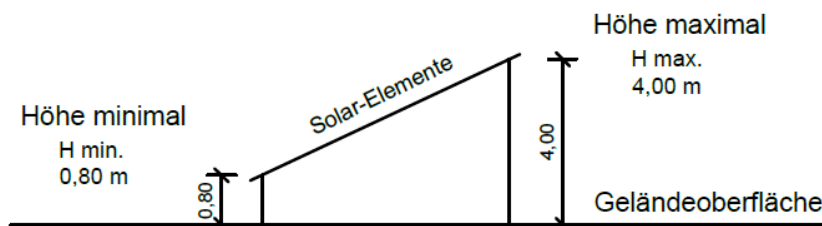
Modell-Layout und Bauliche Aufstellmaße PV-Module (Enerparc AG)
